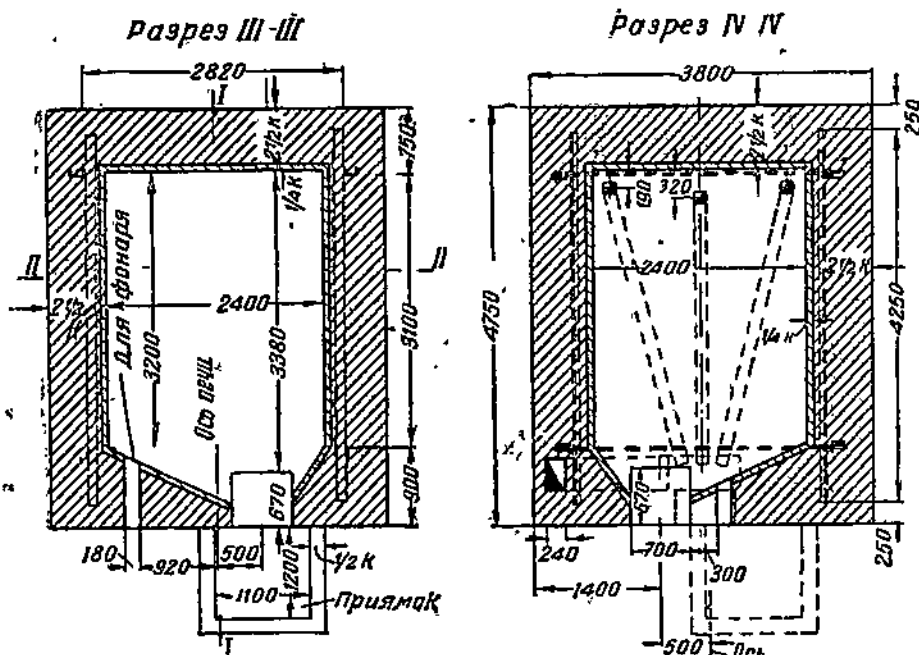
Жаровая двухъярусная печь площадью подов 16 м² — планы.
